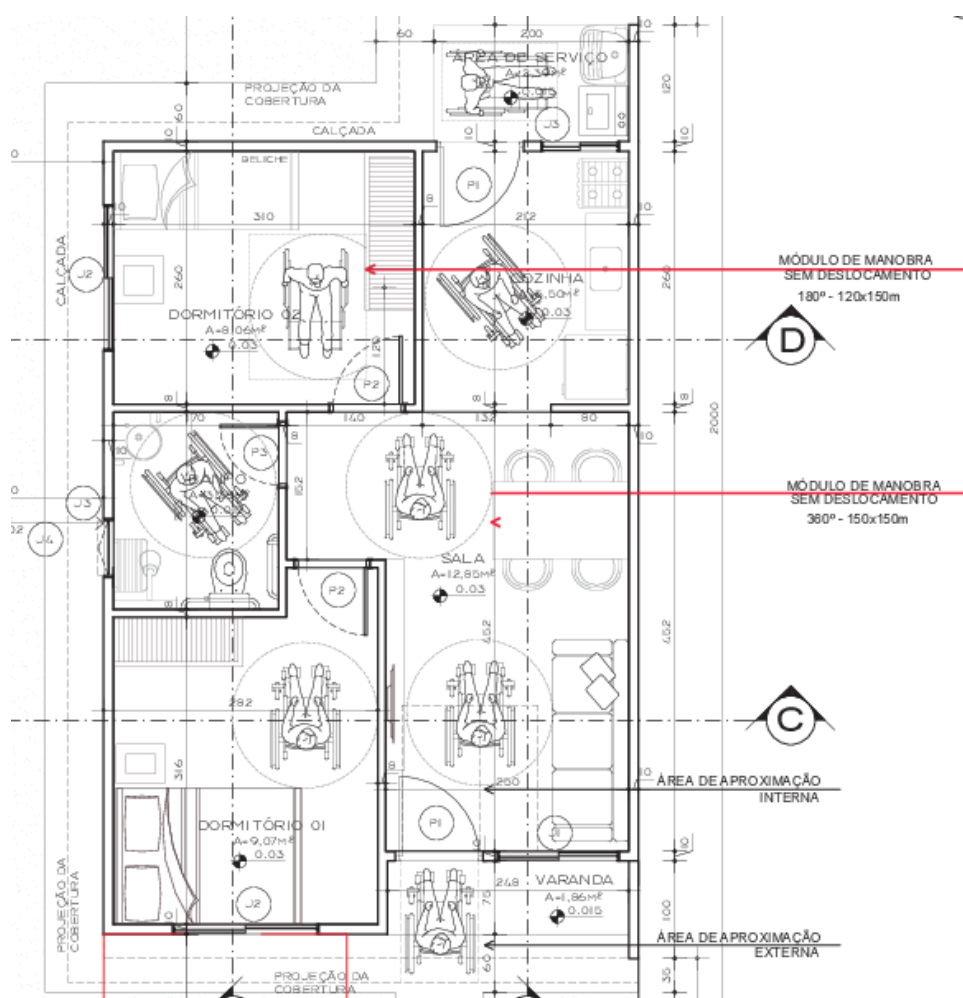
Planta baixa casa acessível – PCD (sem escala).
